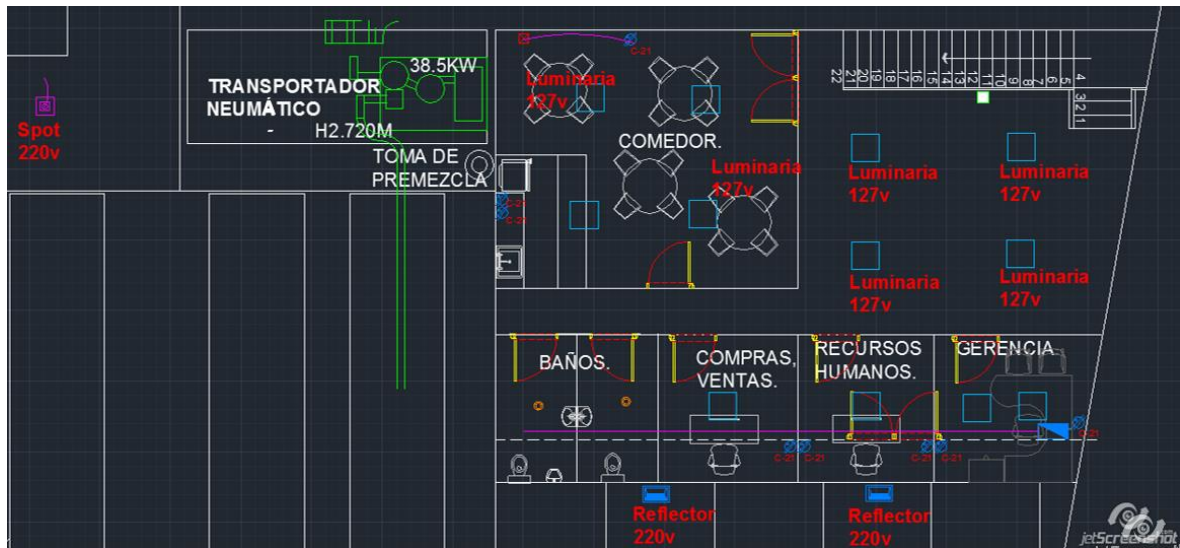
Plano de alumbrado, planta alta, oficinas y comedor.
